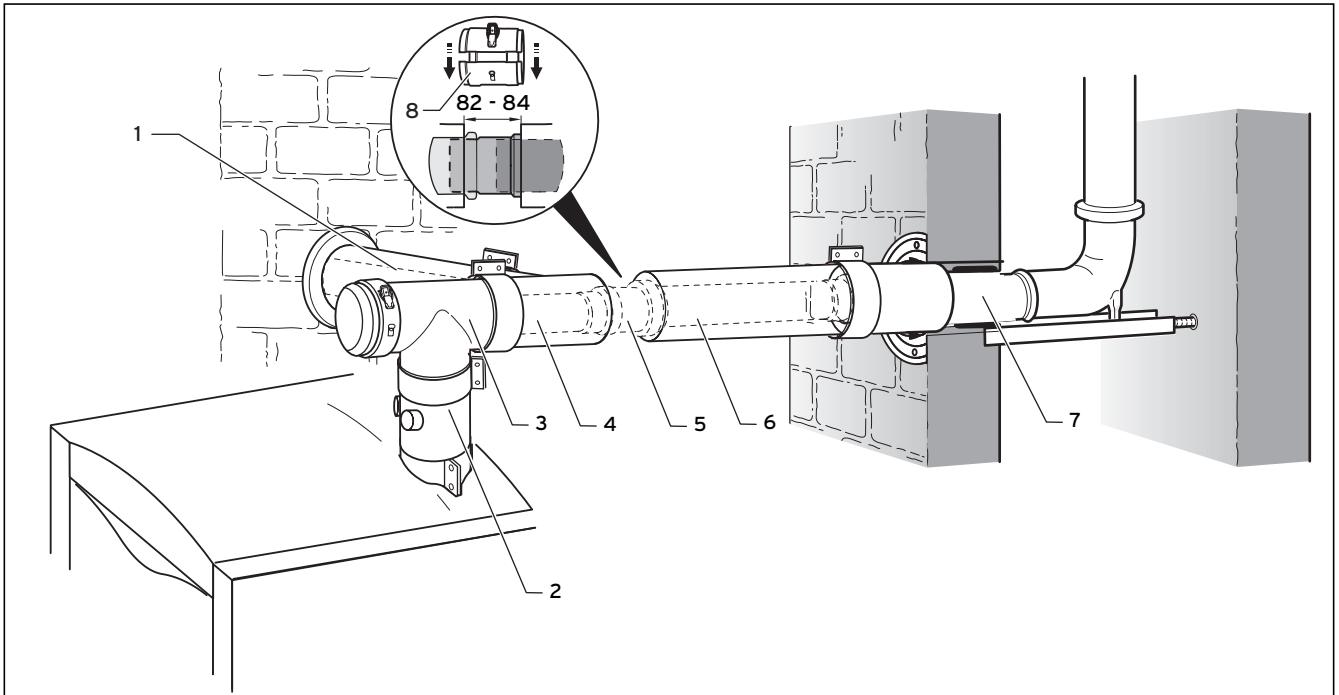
Монтаж подвода воздуха через наружную стену
